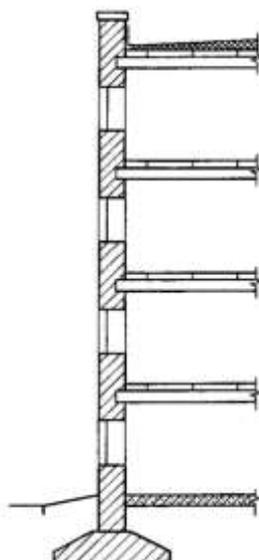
Сопряжение наружной стены с плитами перекрытия и покрытия
